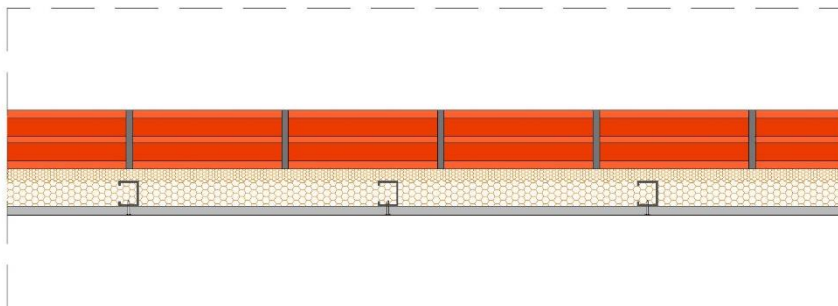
Detalle muro fachada posterior. 2015. Fuente propia.
